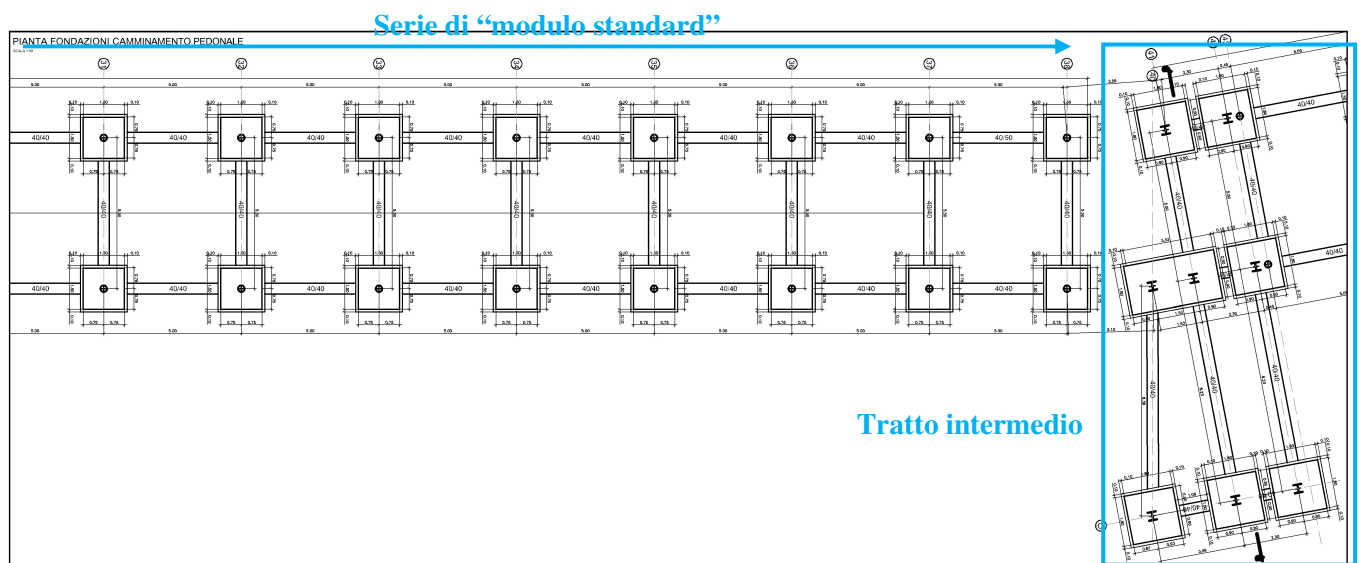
Estratto pianta delle fondazioni del Camminamento pedonale
